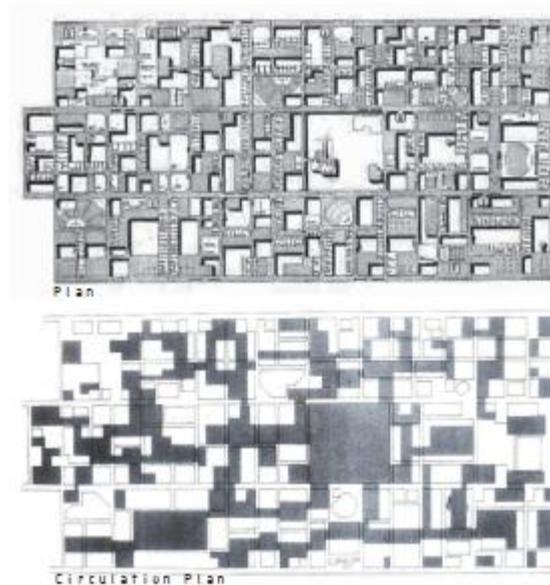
Planta (superior) e a planta de circulação (inferior) para a Universidade Livre de Berlim.
